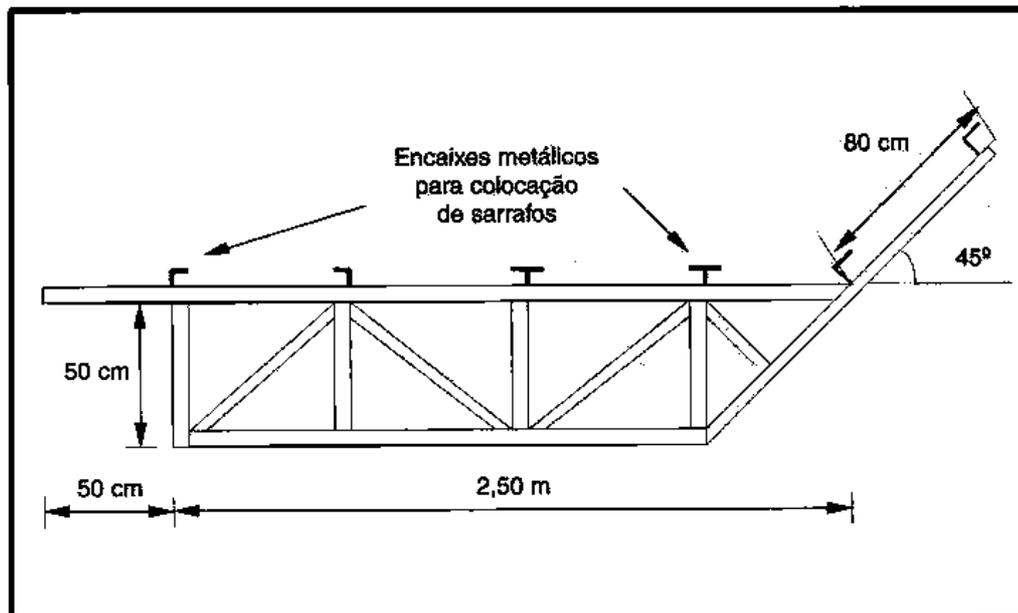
plataforma de proteção fixa – suporte metálico (ARAÚJO, 2002)
